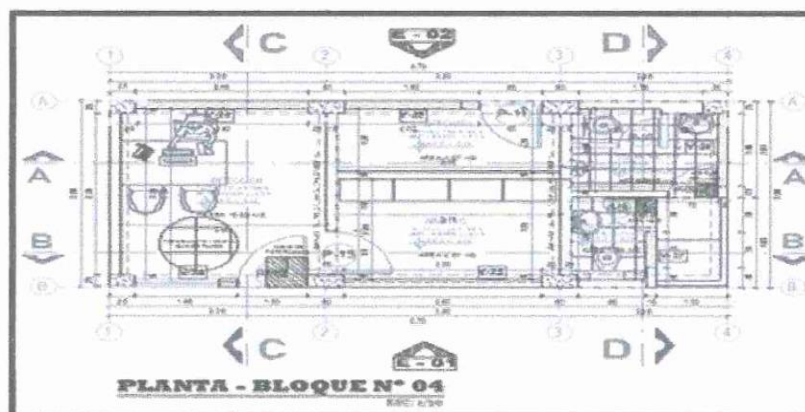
PLANTEAMIENTO BLOQUE N° 04
